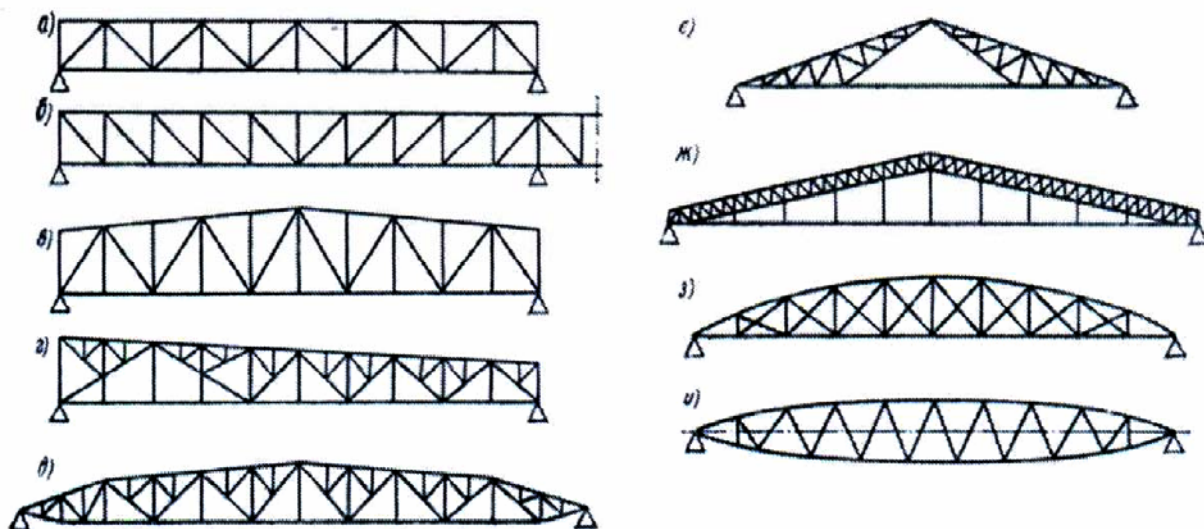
Схемы стальных балочных ферм пролетом от 36 до 100 м:
